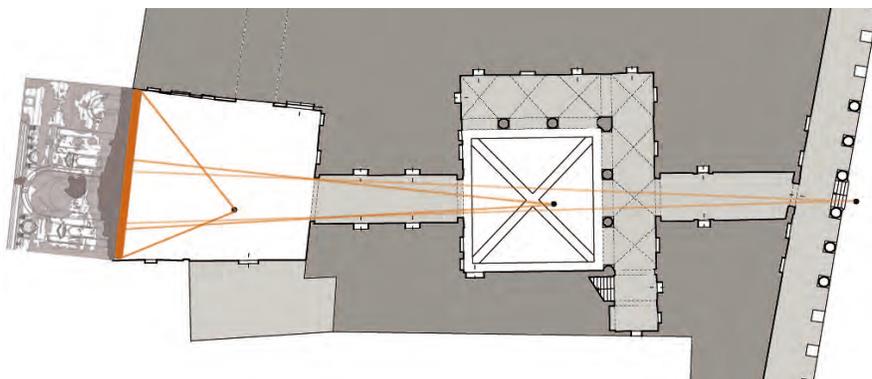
Rappresentazione in pianta dei rapporti che intercorrevano tra il cannocchiale prospettico e la scena dipinta. I tre punti indicano l'osservatore che attraversa il cannocchiale prospettico stando in tre punti: all'esterno dell'edificio, nel cortile d'onore, nel secondo cortile dalla posizione privilegiata.
